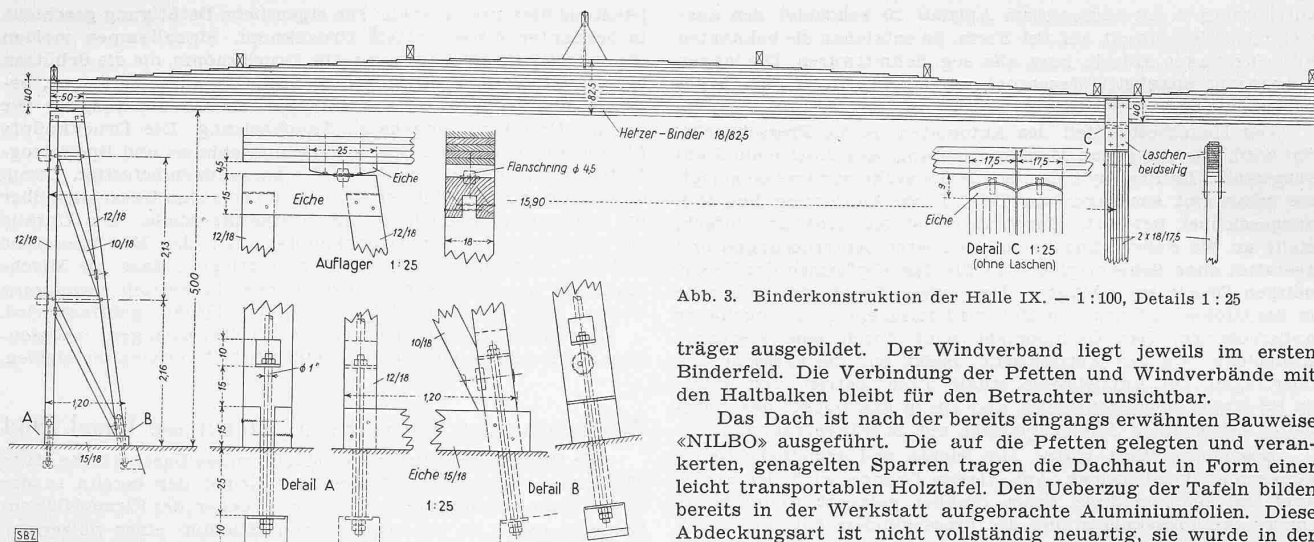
Binderkonstruktion der Halle IX. — 1:100, Details 1:25
